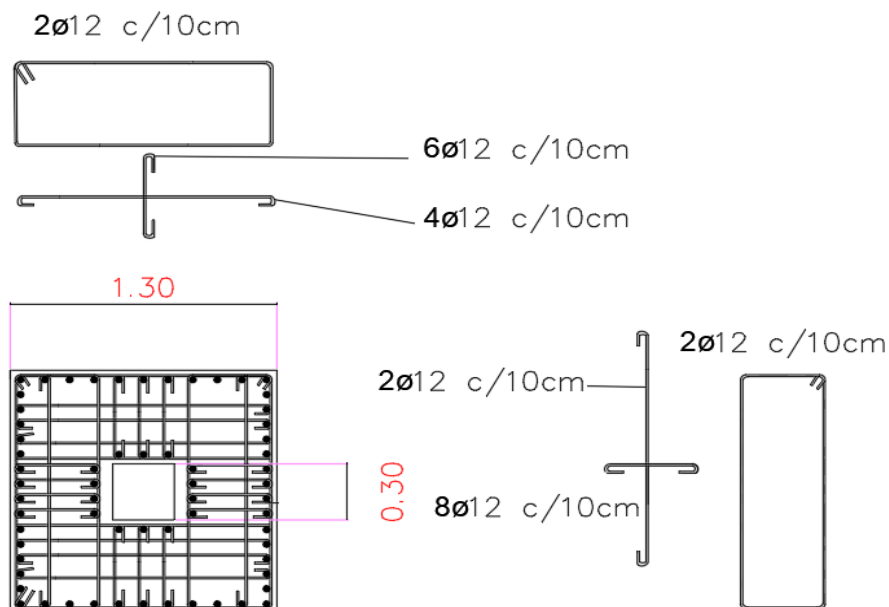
Armadura transversal en las zonas extremas de la parte intermedia de las pilas (Desde H = 16 a H = 24 m y desde H = 47 m a H = 53 m).
